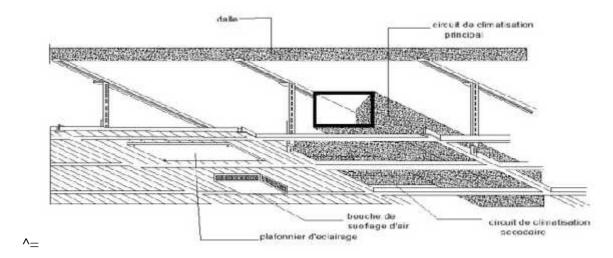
faux plafond. Source: http://www.europe69construction.fr/
